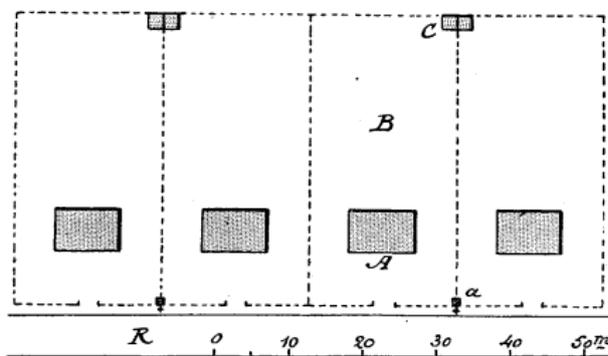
Plan général des maisons ouvrières de la ferme de La Trousse.
